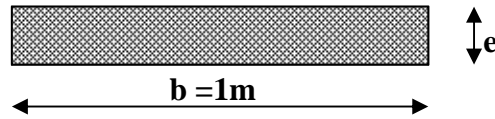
Section de la dalle pleine 'a' à ferrailer
